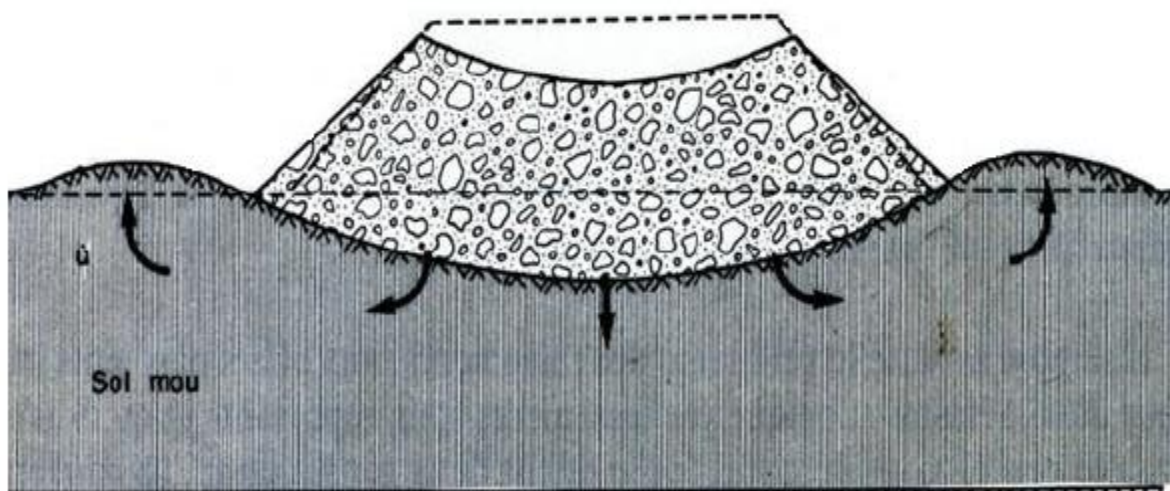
1 schéma de rupture par poinçonnement d'un remblai sur une couche molle
